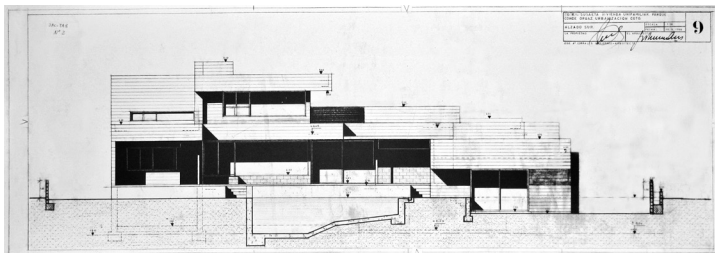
Corrales, José Antonio. Vivienda Susaeta. Segunda versión, construida. Alzado de acceso-Alzado al jardín. Proyecto de ejecución, 1966. Archivo Corrales.
